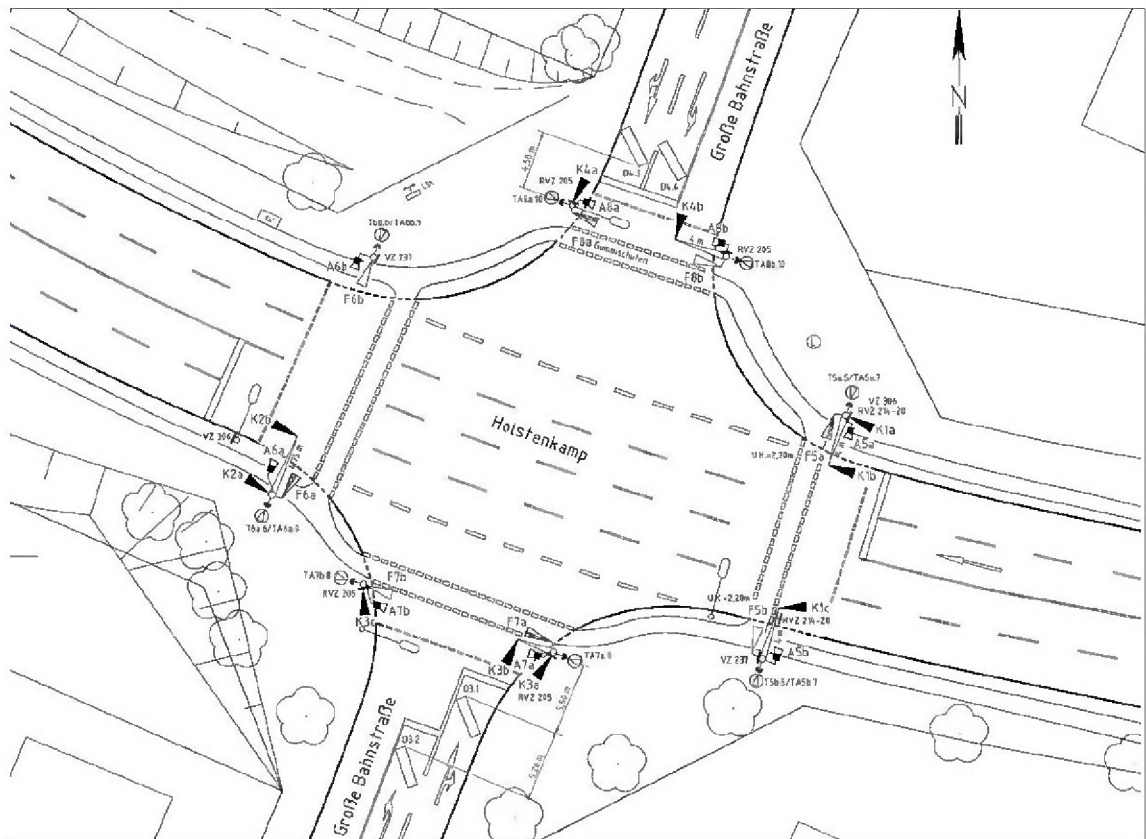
Signallageplan Holstenkamp/Große Bahnstraße – Bestand (06/1043-04-02/02)
